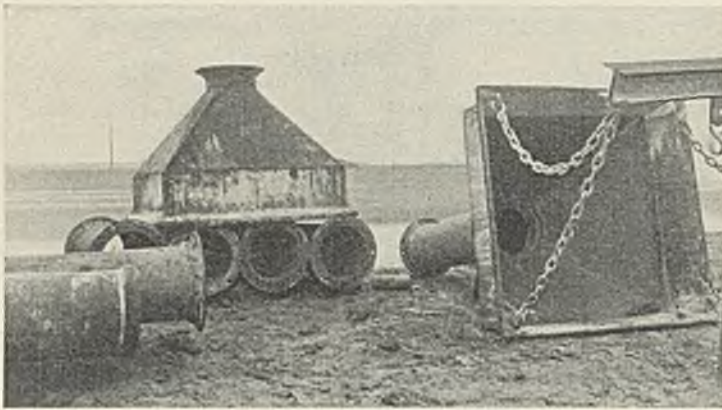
Trichter mit Aufhängevorrichtung, Röhre, links Schlußrohr mit Wulstisen.
